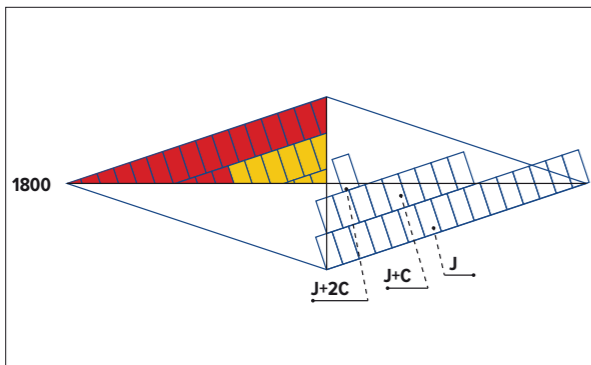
Пример раскладки разуклонки ПЛИТ PIR SLOPE 3,4 % для формирования уклона
